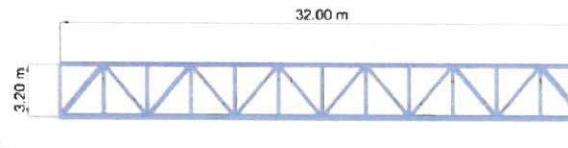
Poutre treillis niveau haut R+2 de l'Auditorium
